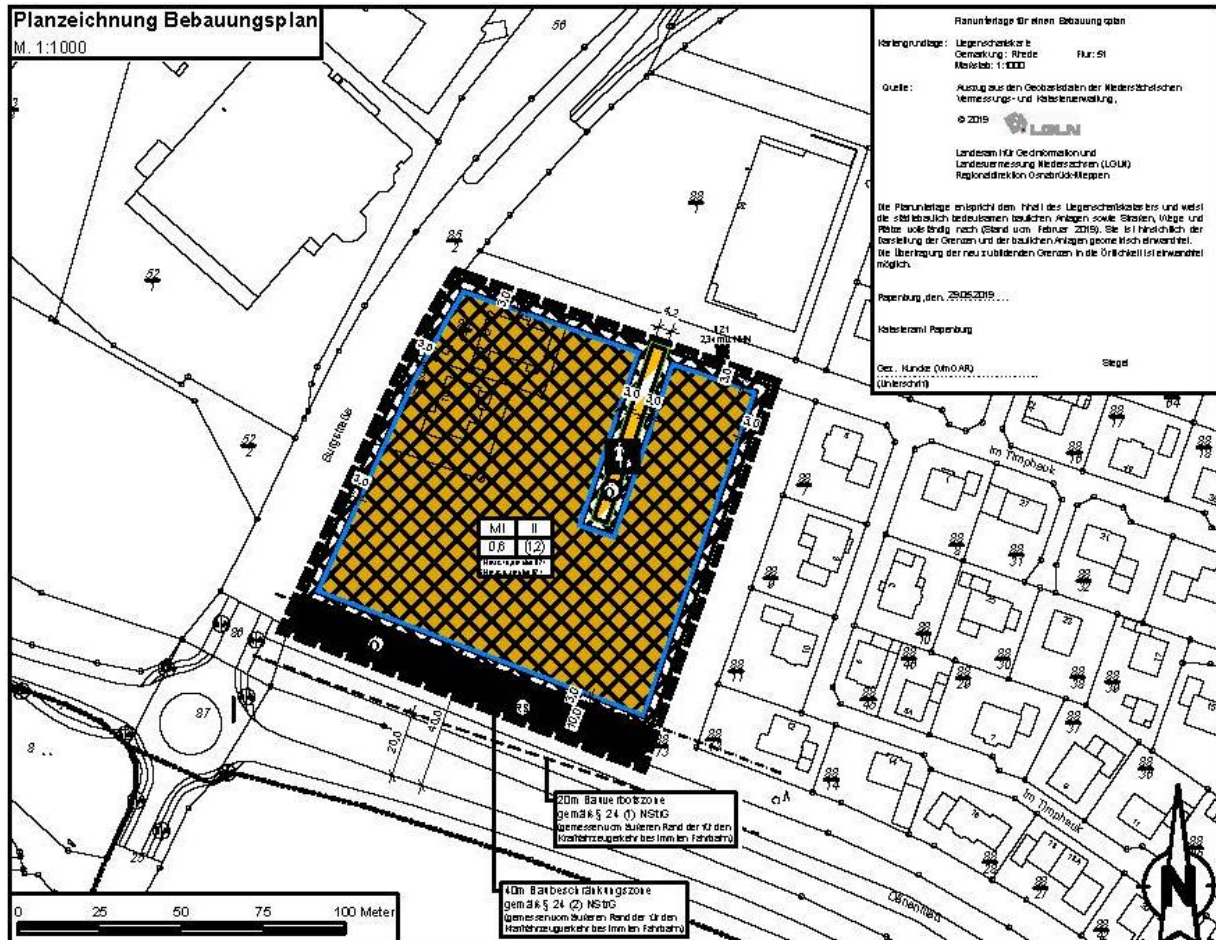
BPlan Nr. 18. (6. Änderung)
